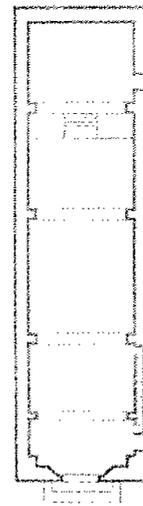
Bóveda con pilastras, planta del Templo en Jantetelco, Mor.
